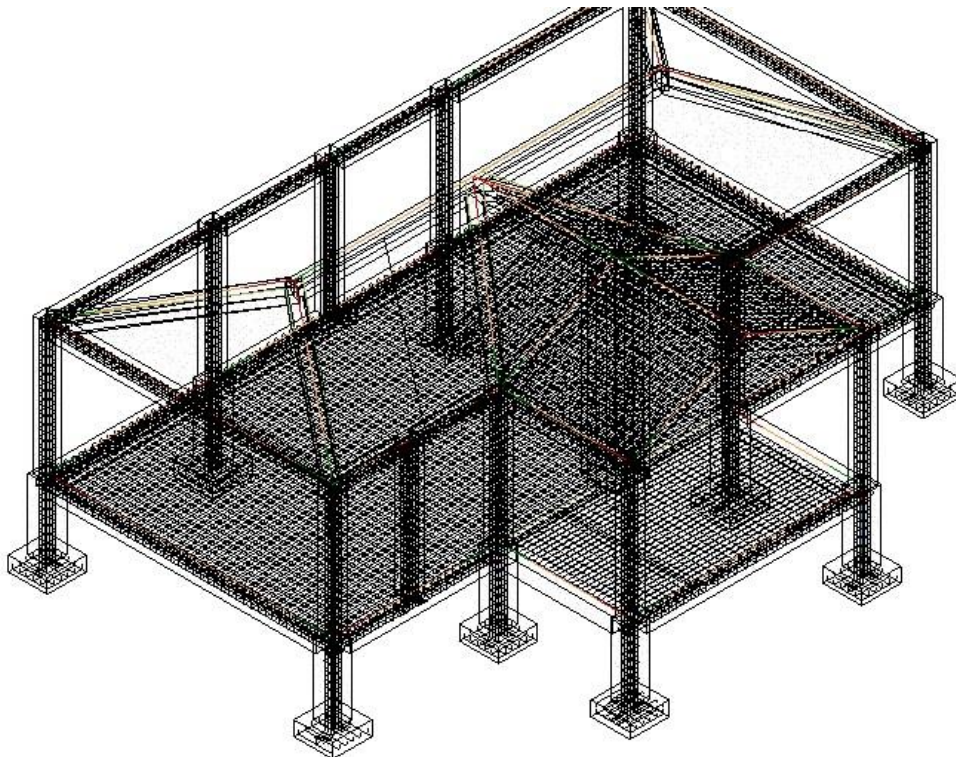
plano Planta con detallado de columnas y losas del modelo estructural
